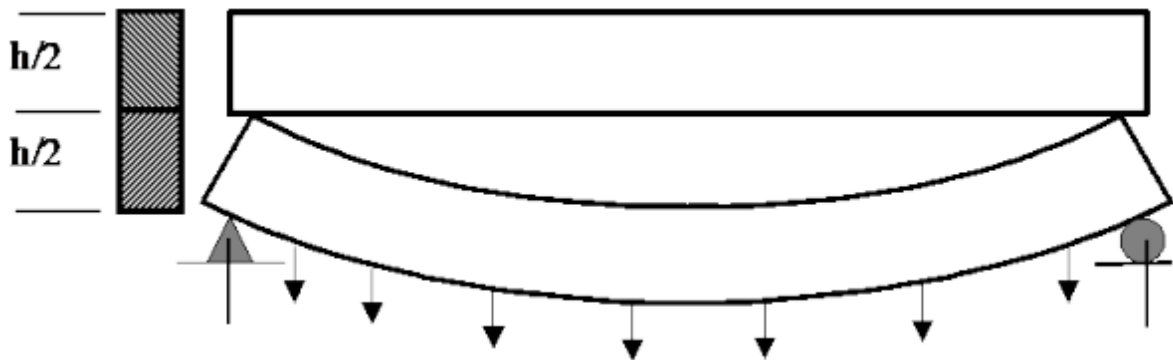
Fléchissement d'une poutre mixte avec glissement de la dalle par rapport à la poutrelle métallique
